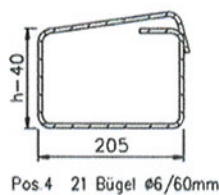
Bauseitige Anschlussbewehrung für SBM20 Q10 und SBM20 Q12
